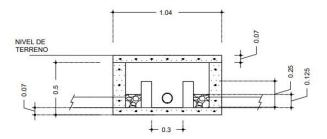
Dimensiones y detalle de la Cámara-Filtro de Distribución.
